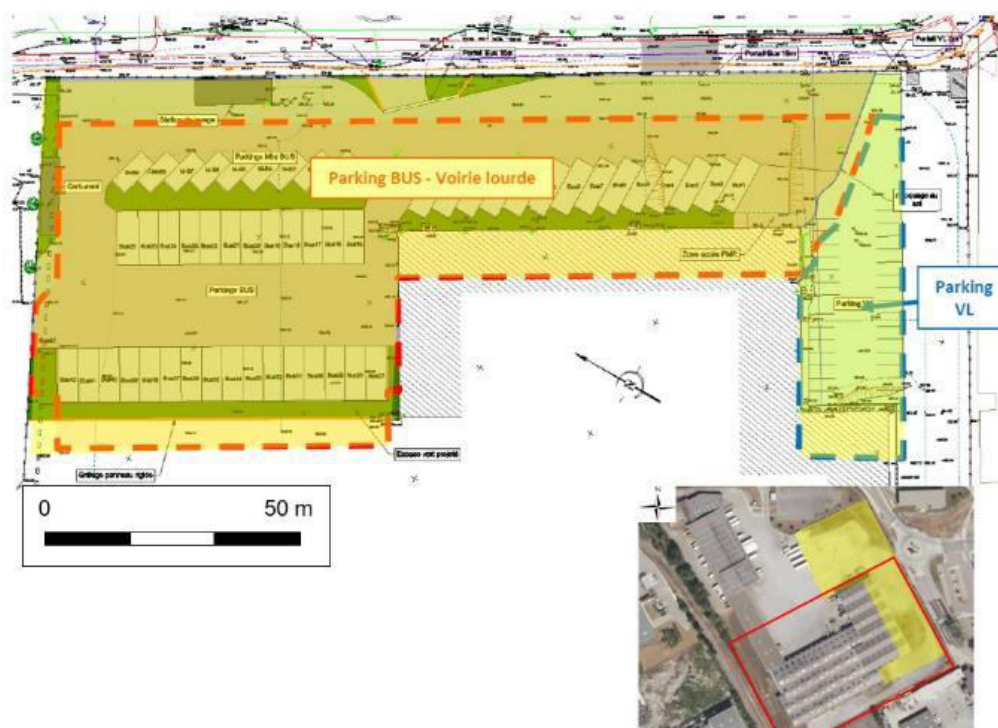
EXTRAIT PLAN ETUDE DE 2 SAVOIE GEOTECHNIQUE (PLAN AMENAGEMENT DES EXTERIEURS KEOLIS)
